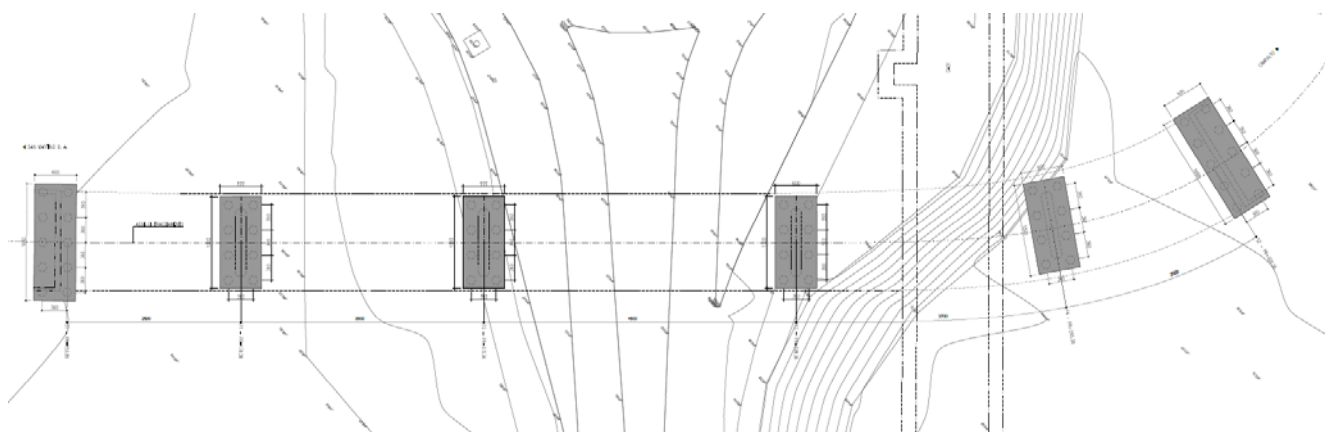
viste e sezioni principali – pianta delle fondazioni
